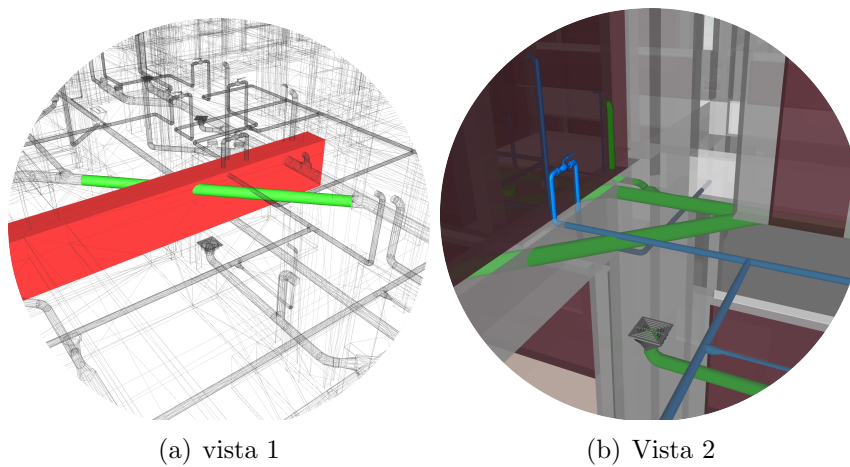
Conflicto entre tuberías y viga. *Fuente: Elaboración propia.
